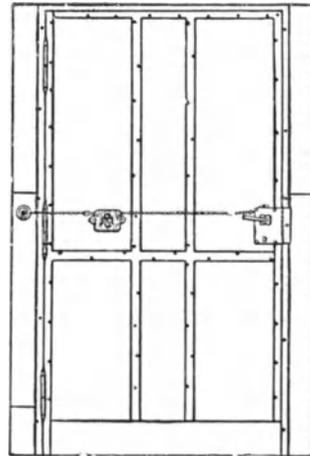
Montageanordnung des Türöffners für Kastenschlösser.
